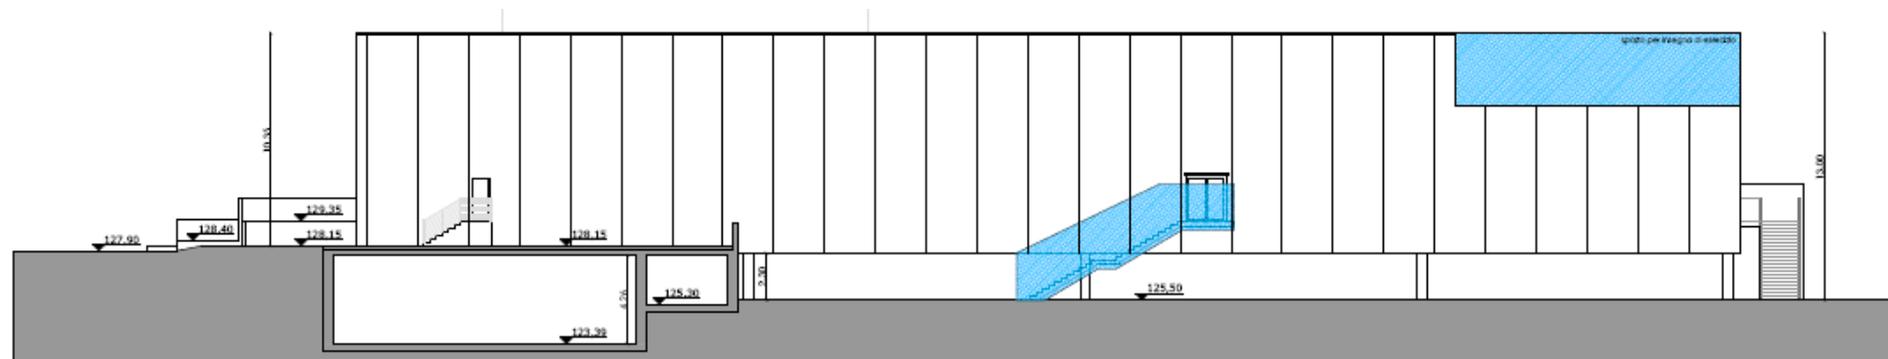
Prospetto Ovest (Variante approvata - Tavola 3b)
